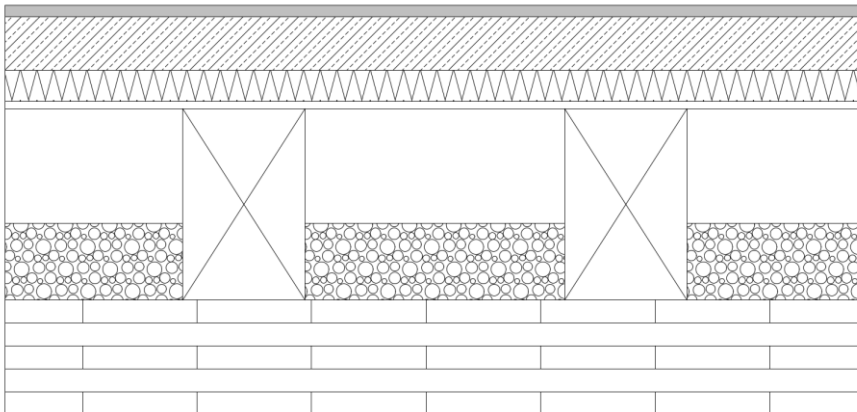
Schema einer Rippendecke mit Fußbodenaufbau
